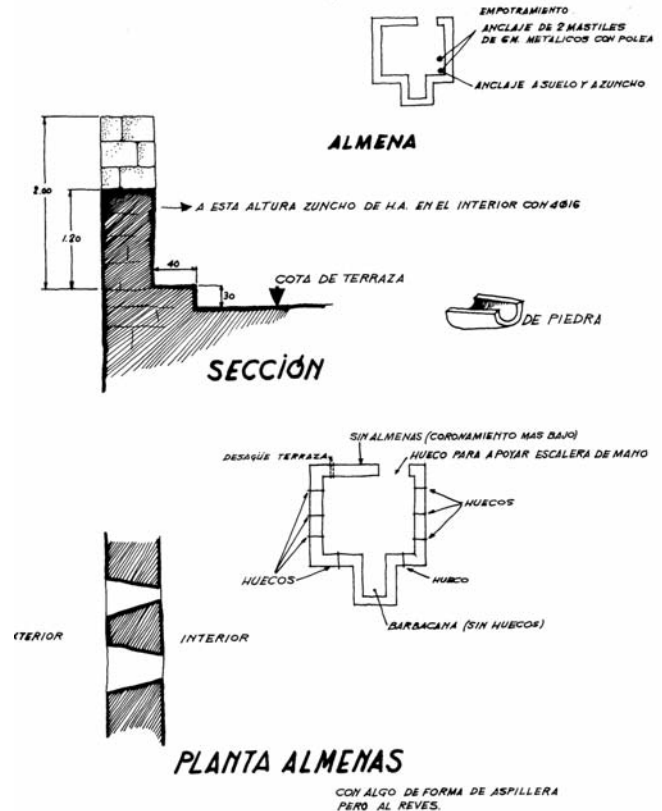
1968-71 Restauración de la "Torreta". Anónimo. Detalles
